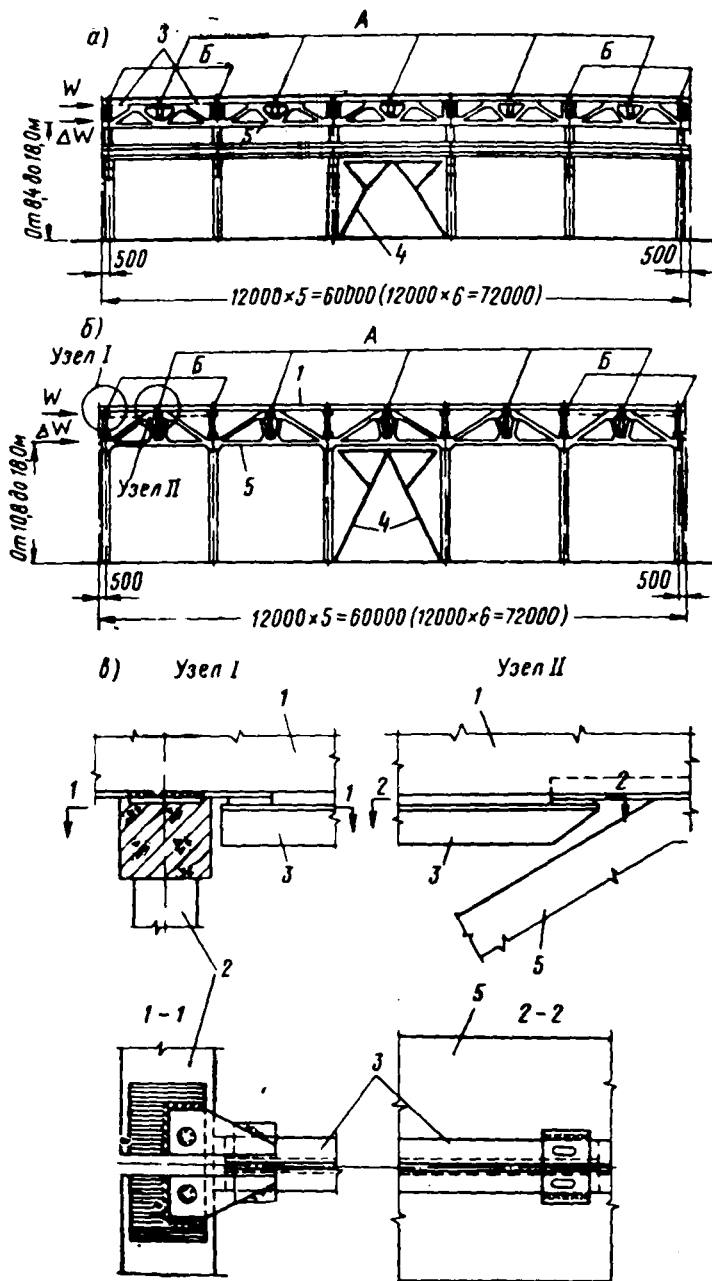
Схемы и детали крепления связей в зданиях с подстропильными конструкциями
